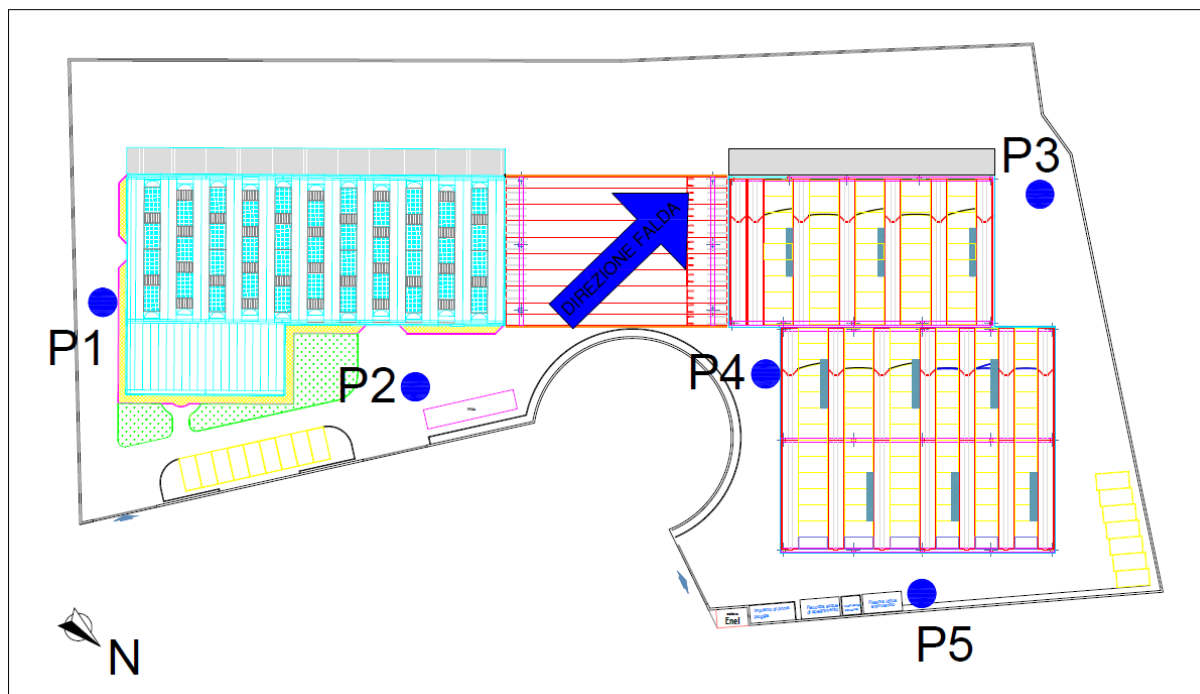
Planimetria generale con indicazione del posizionamento dei piezometri
